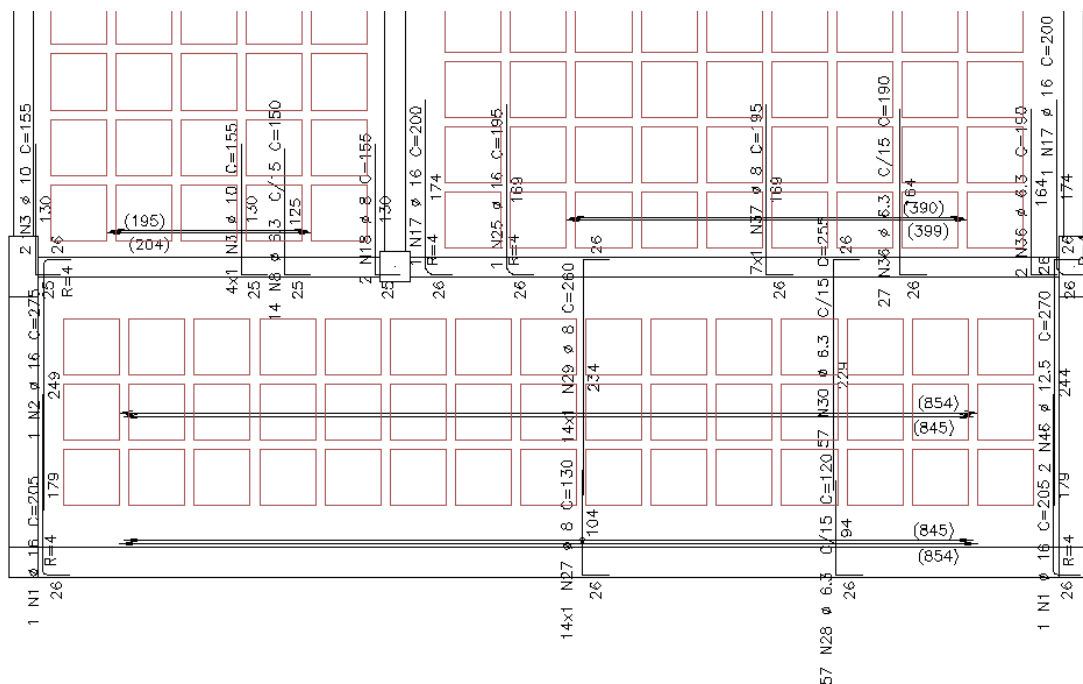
Armaduras verticais negativas nas lajes L10, L11 e L12 do pavimento Biblioteca da Solução com Laje Nervurada
